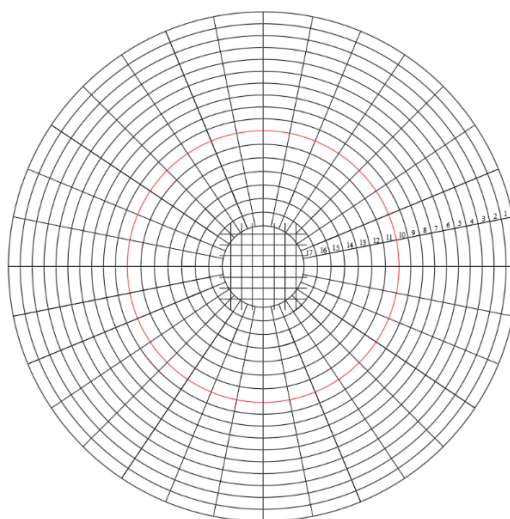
Disposição das armaduras radiais e circunferenciais
